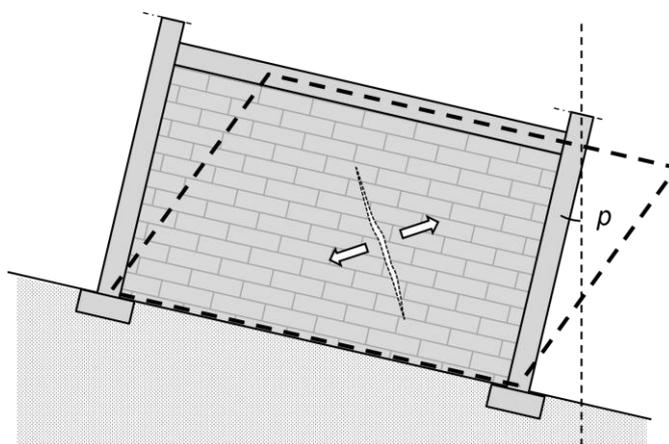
exemple de fissures diagonales induites par la mise en parallélogramme du mur de remplissage en cas de mise en pente du terrain
